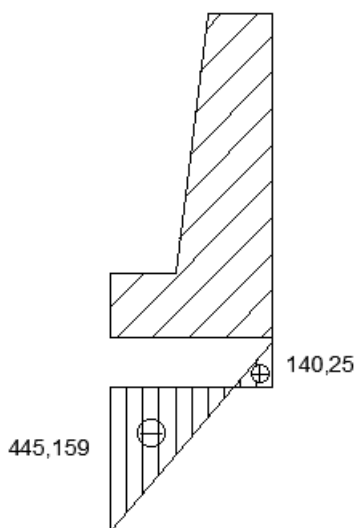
Эпюра крайних напряжений в грунте подошвы стенки
